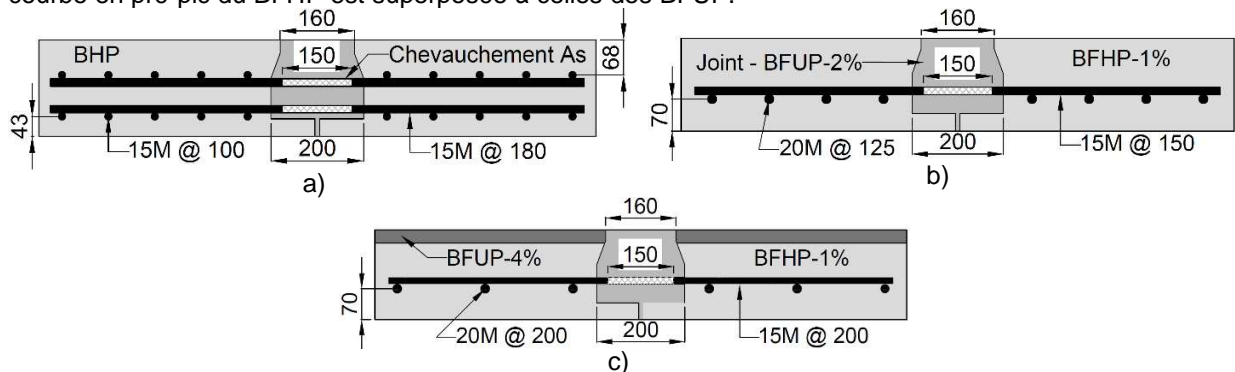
Section des dalles avec joint de connexion, a) BHP, b) BFHP, c) Hybride (en mm)
